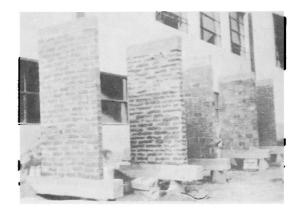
Trasporte de los muros a la máquina de ensayo.
